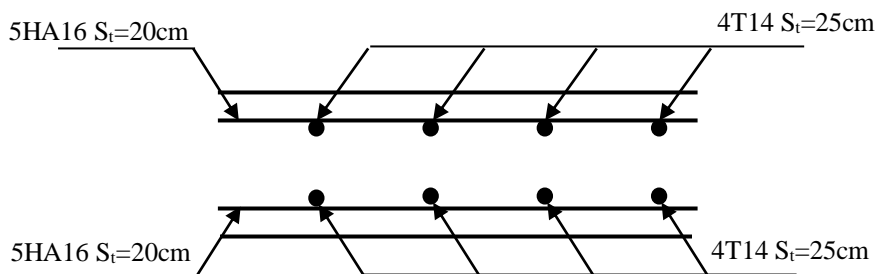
Vue en coupe du ferrailage de la dalle.
